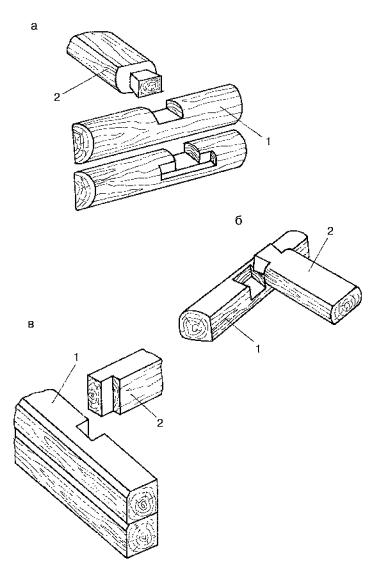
Врубка балок пола в стену дома: а — соединением «ласточкин хвост»; б — сковороднем впотай; в — косым шипом; 1 — стена дома; 2 — балка пола
